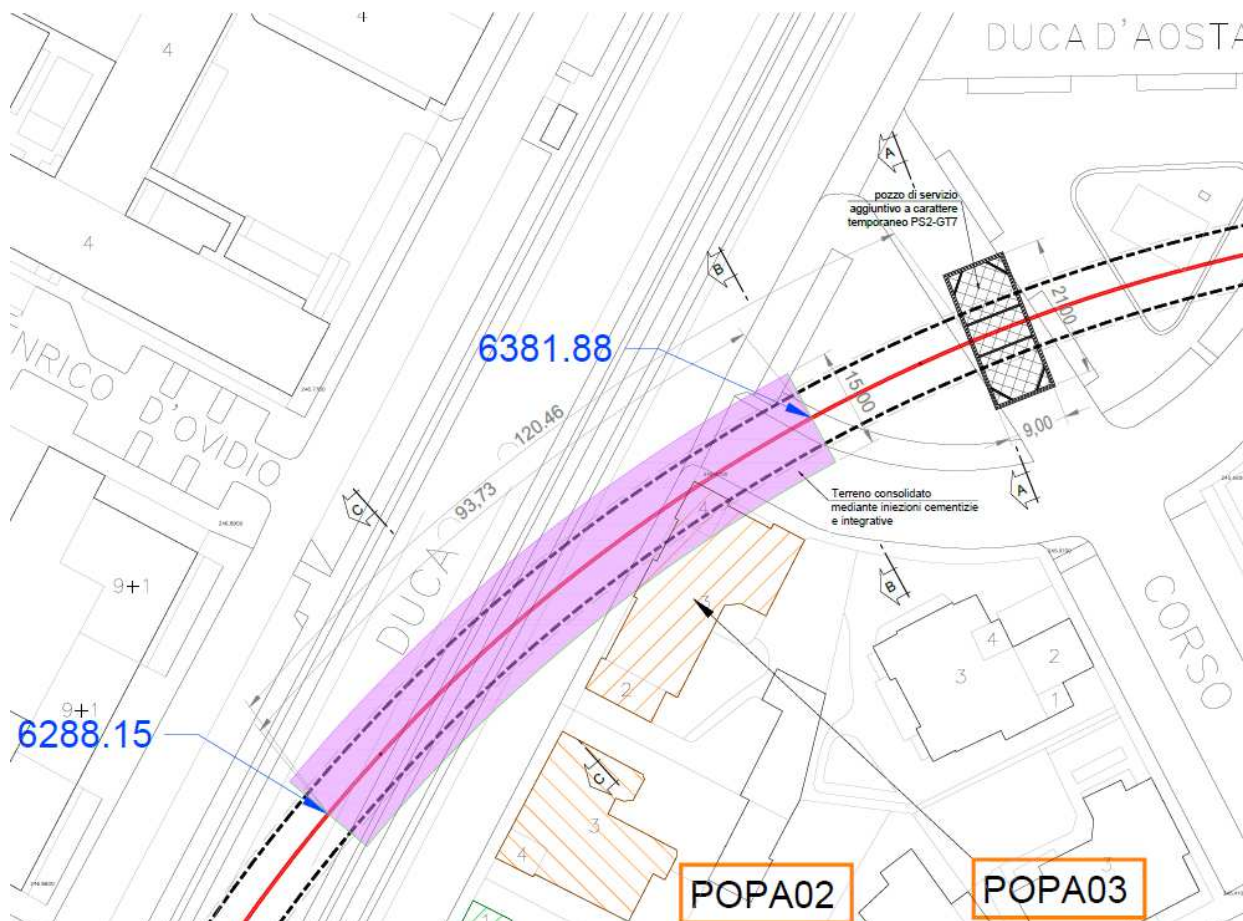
Planimetria dell'area in cui è ubicato il pozzo PS2-GT7.
